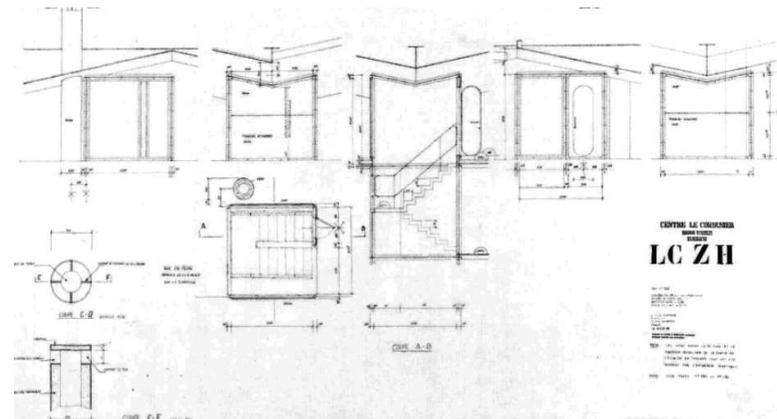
Detalle constructivo de las escaleras para el acceso a la terraza. plano nº 158, 9 de agosto 1966.
